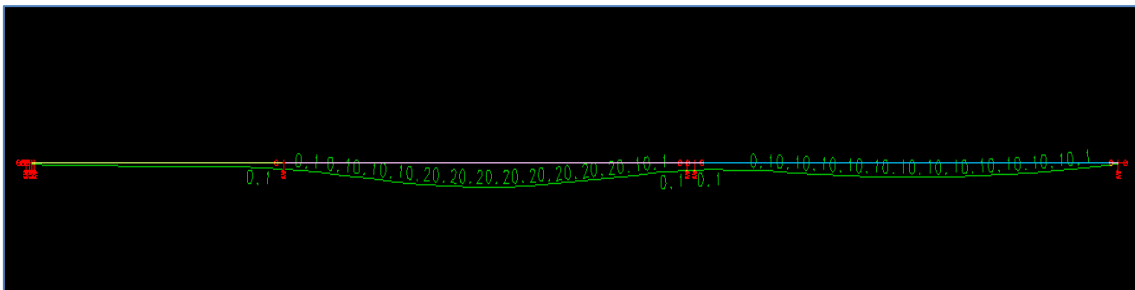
Deslocamentos verticais viga V15 do 1º pavimento, concreto armado (CAD/TQS).
